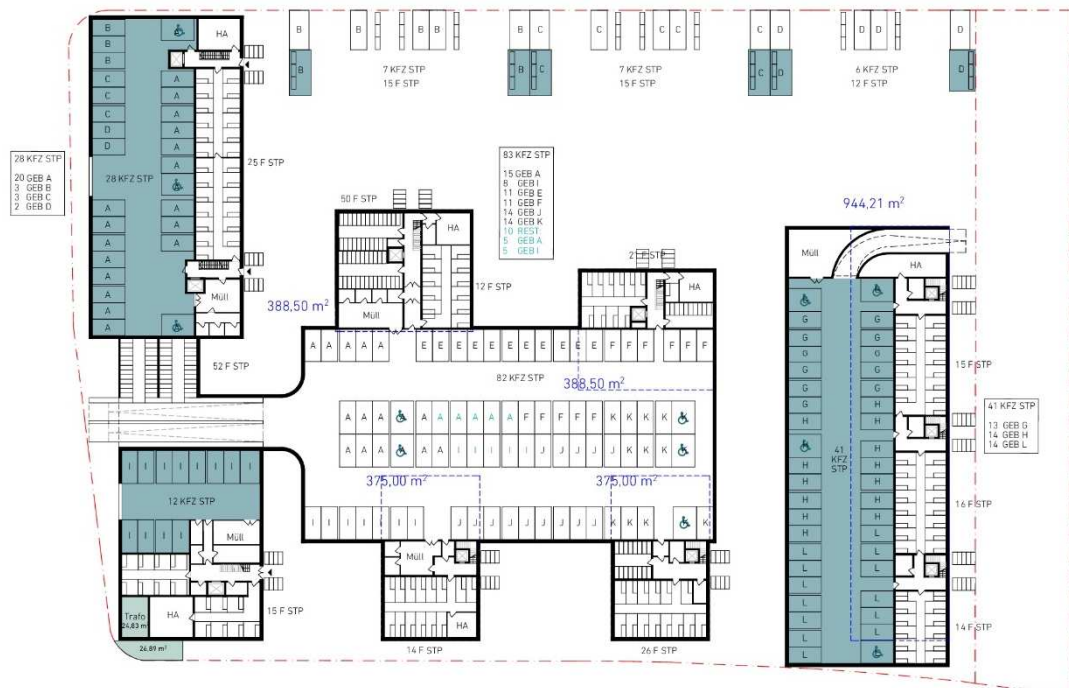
Städtebauliches Konzept, Lageplan Garagen- und Tiefgarangengeschoss, Stand 2017
